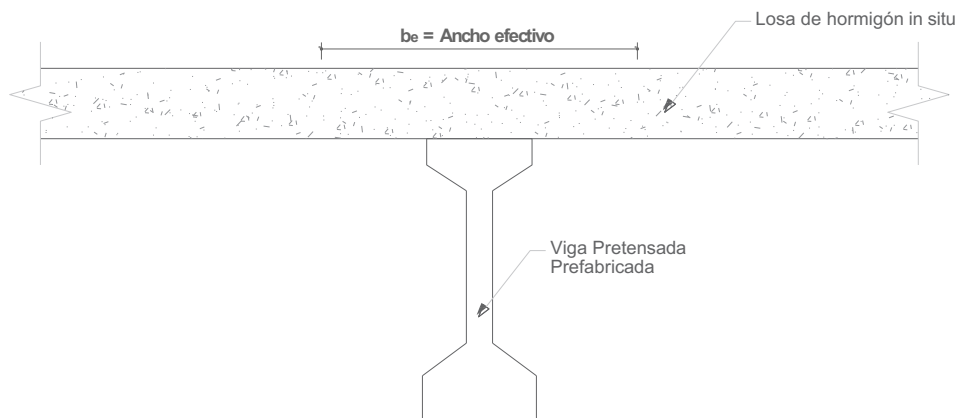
Ancho efectivo de losa para una viga de sección compuesta.
